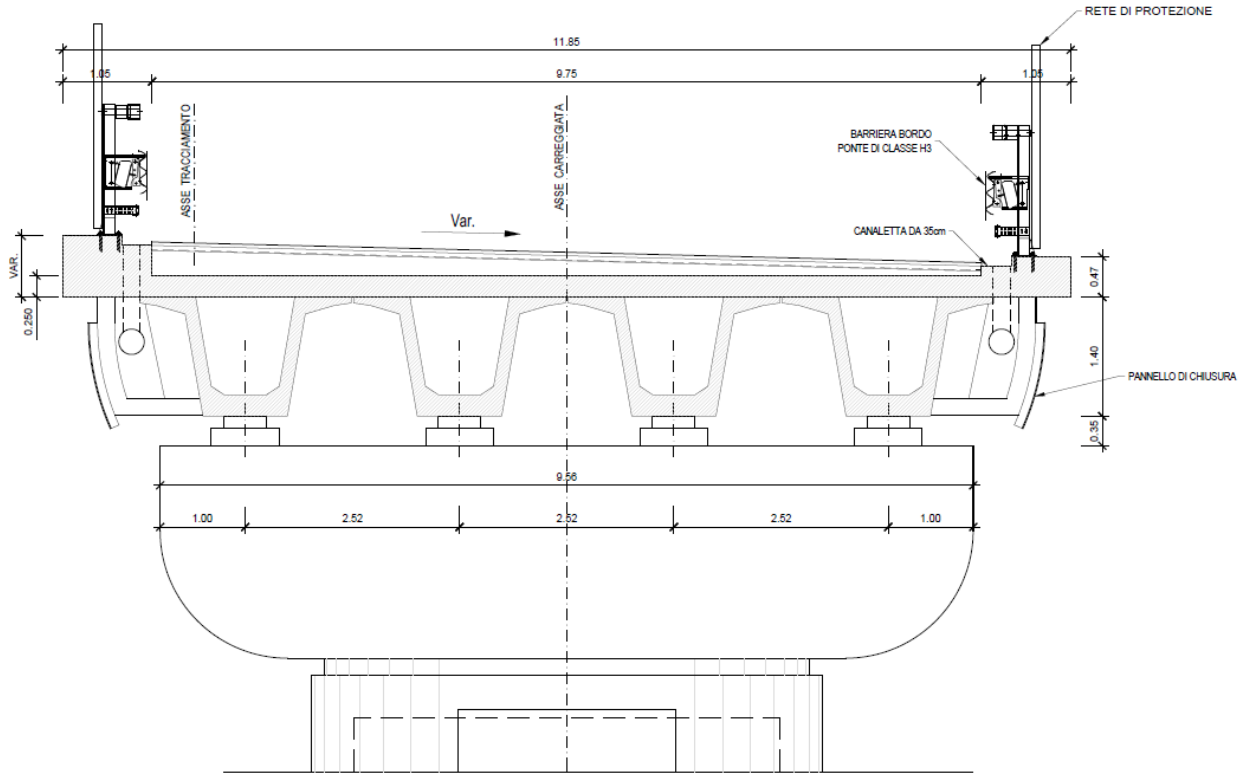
Sezione Tipo Impalcato Viadotto Molino Vecchio.
